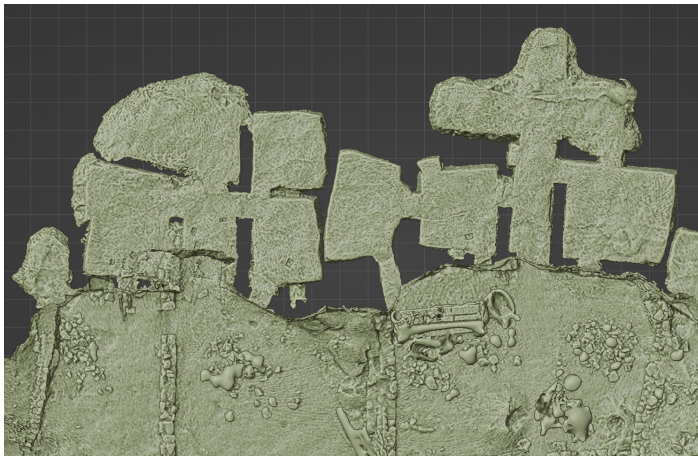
Planta del interior de las cuevas a reconstruir. Fuente: Elaboración propia
